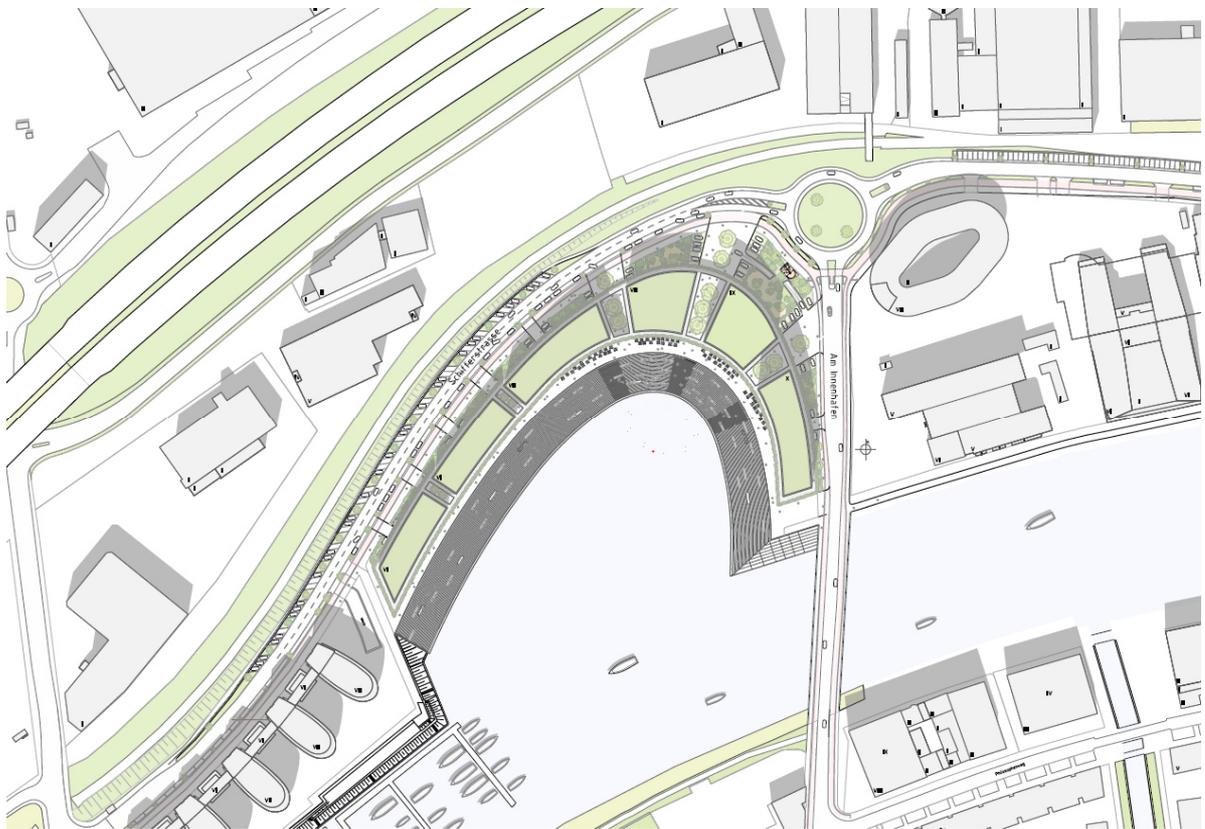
Lageplan des Vorhabens (ohne Maßstab), Stand Februar 2025
